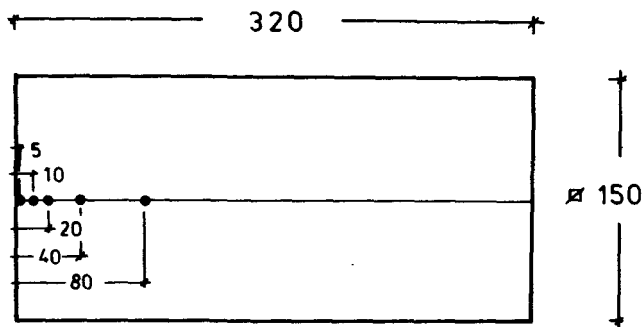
Stahlbetonbetonmeßstein für Wand und Decke
